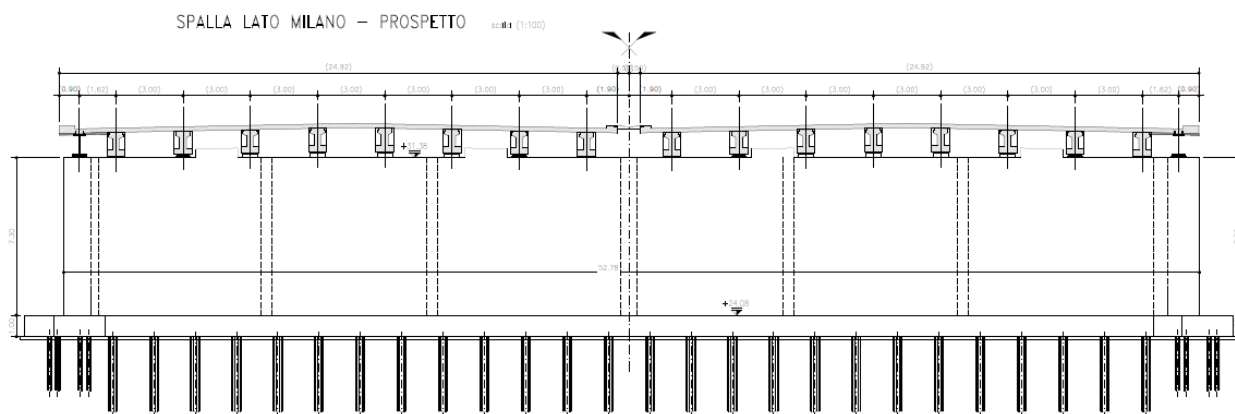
Sezione trasversale spalla lato Milano
